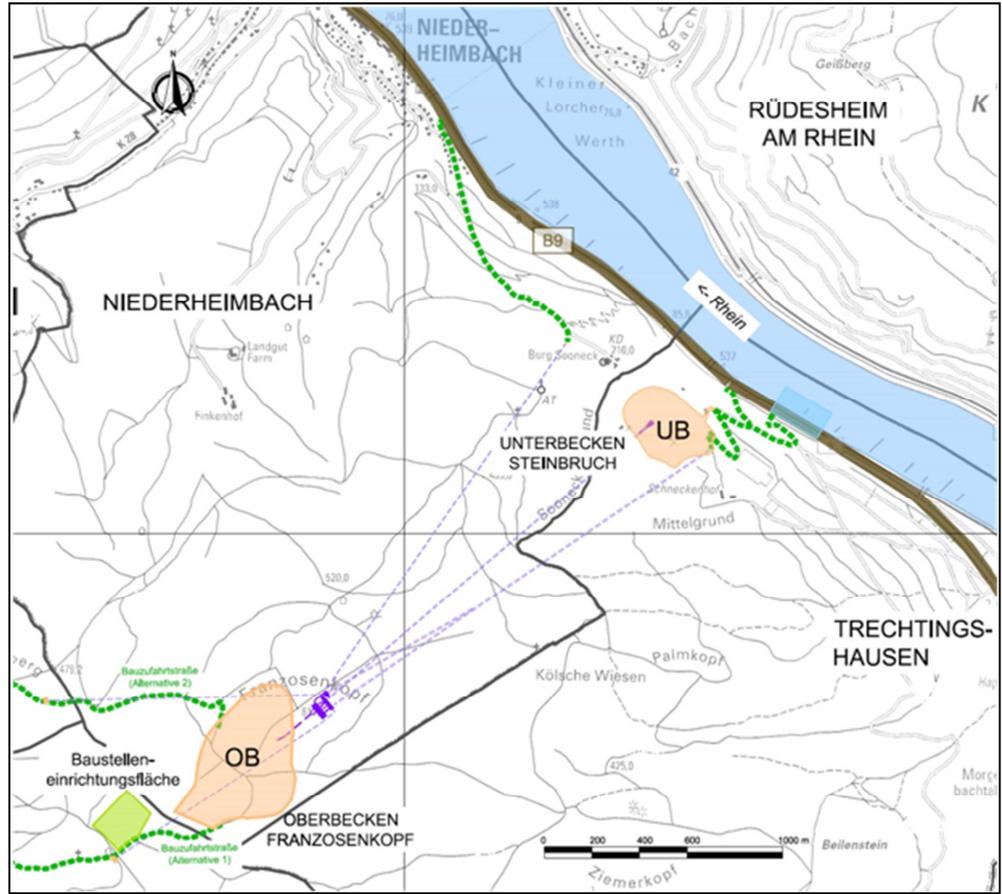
Lageplan des geplanten Pumpspeicherwerks Heimbach
